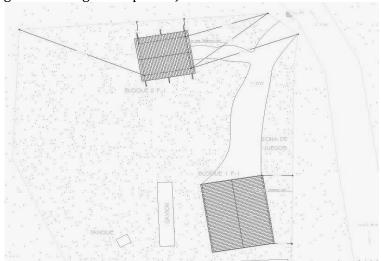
Colegio Campestre Jaime Garzón sede Santa Rosa
